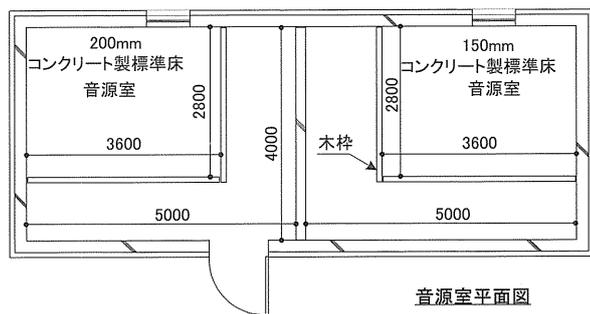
試験体 (200mm厚 コンクリート製標準床使用時)
